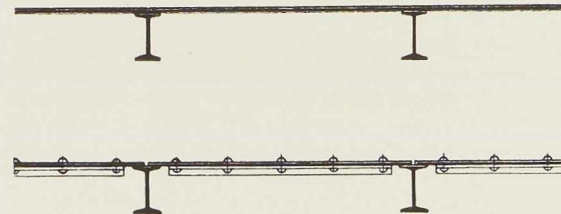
Planchers d'usine dont la tôle est raidie ou non.
